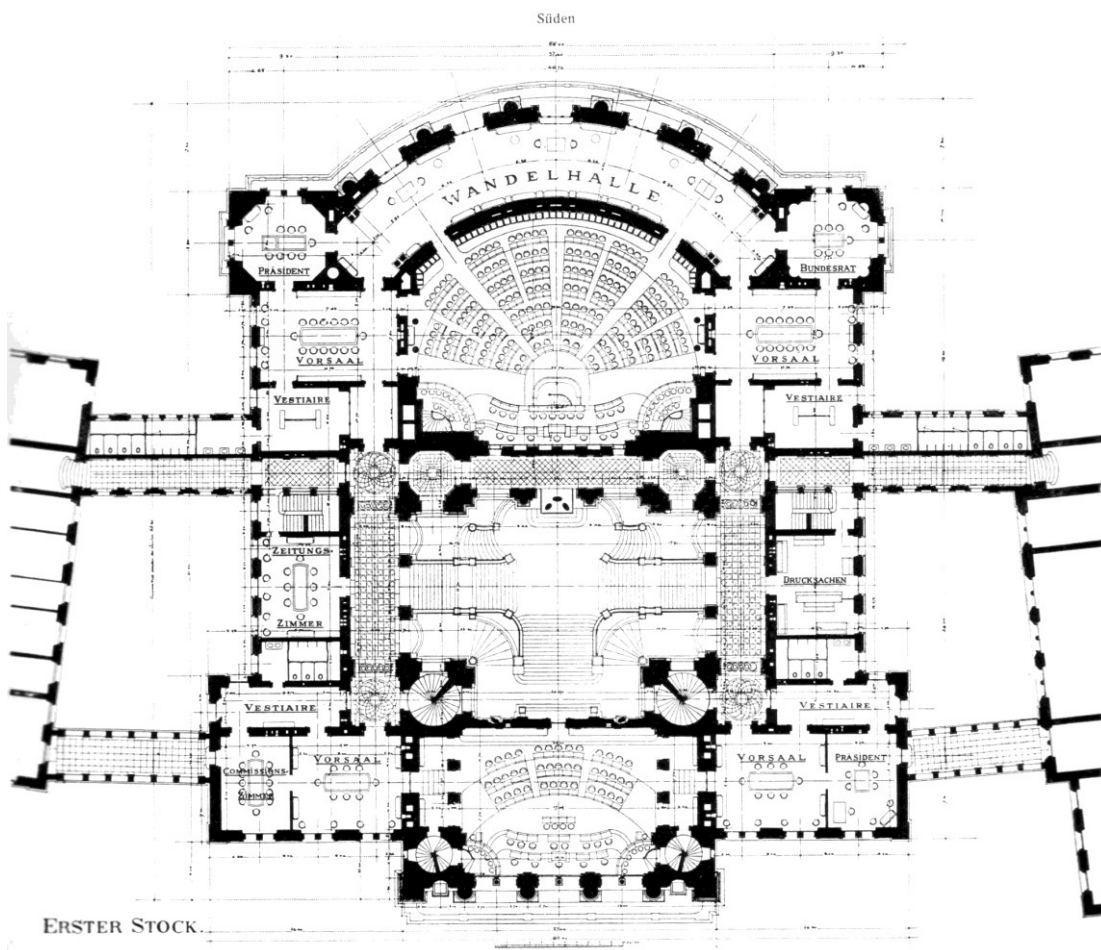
Grundriss des Hauptgeschosses.
